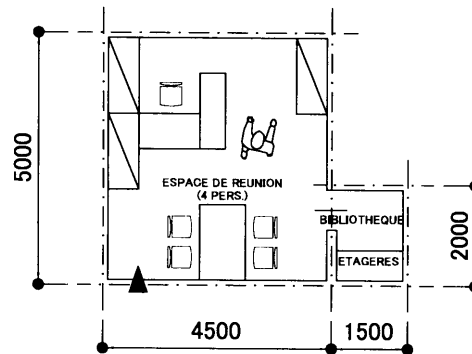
Plan planimétrique du bureau de l'adjoint du chef
